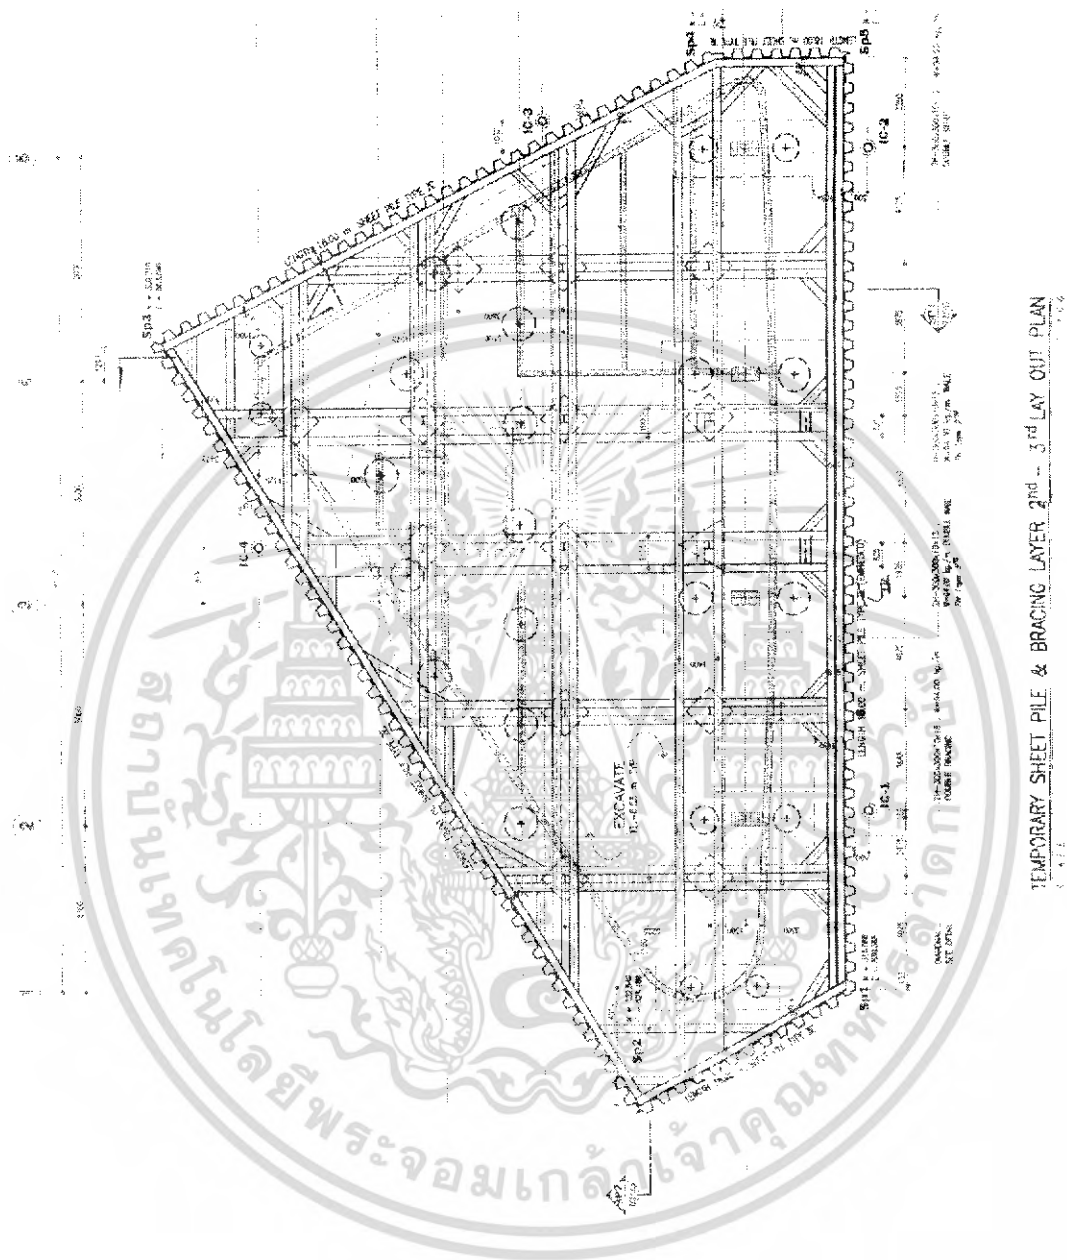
แสดงตำแหน่งและรูปตัด preload strut layer 2 ของโครงการ The Met
